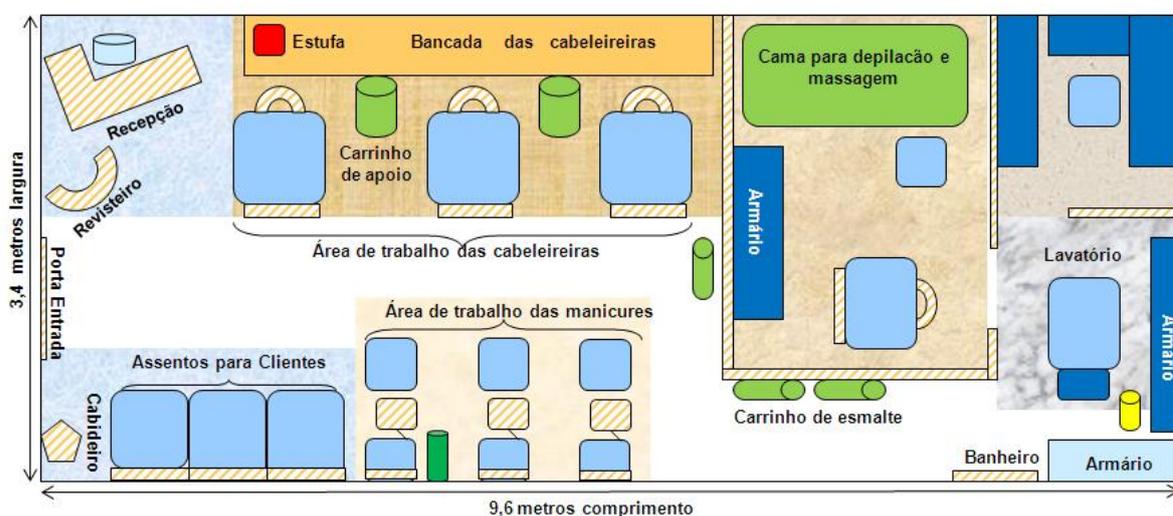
Planta baixa do layout do salão estudado antes da reforma
